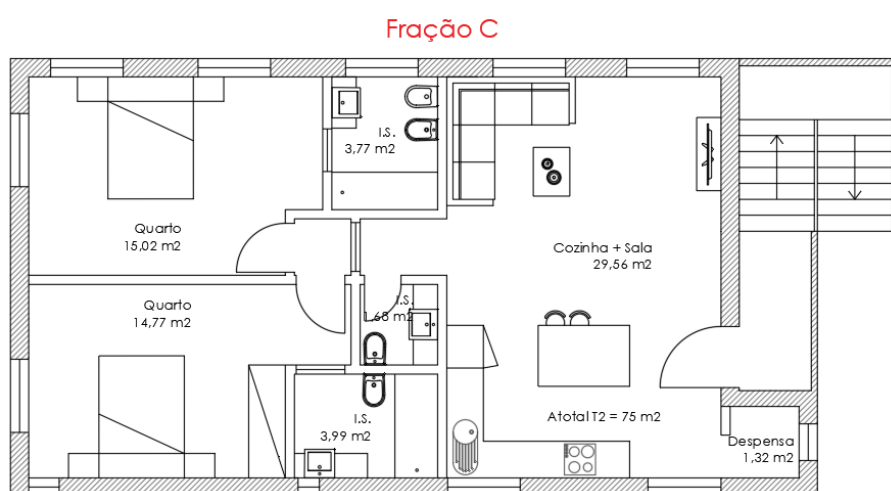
Planta de alteração do Piso 1 - Moradia principal
